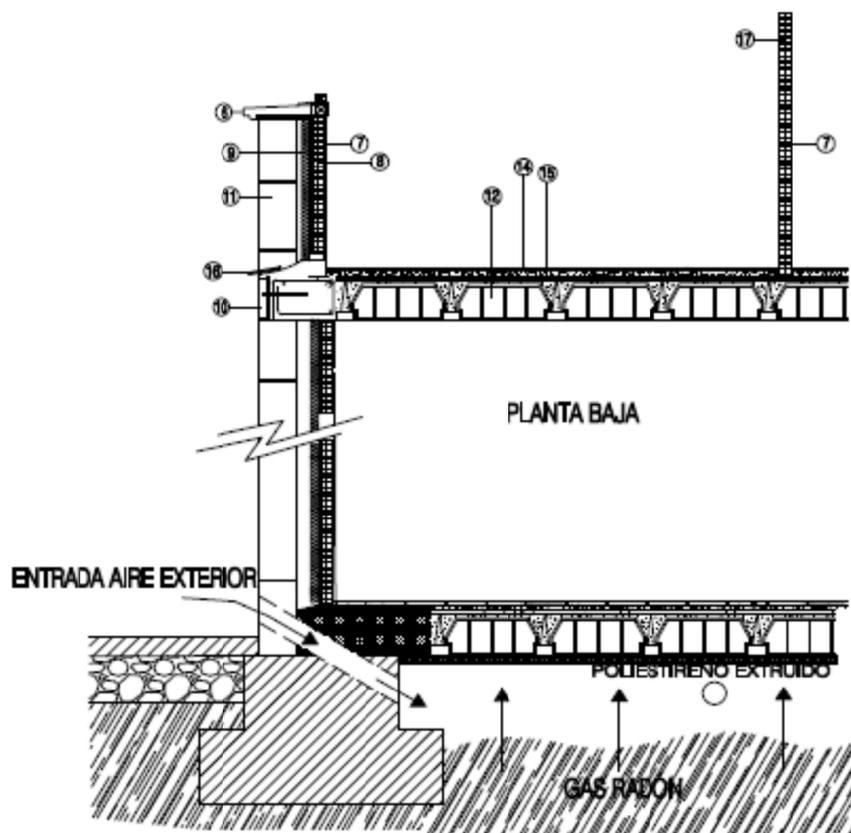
Detalle constructivo. Ventilación cámara sanitaria.
